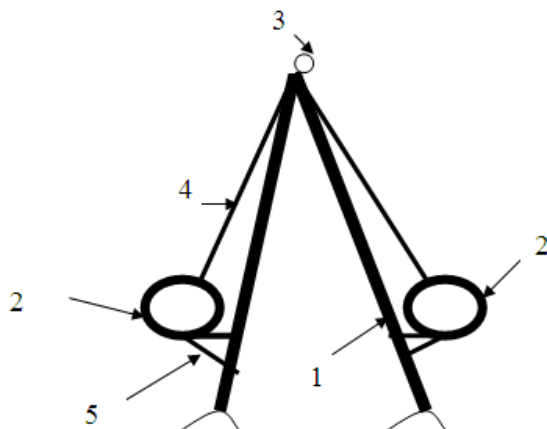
Поперечный разрез мостотоннеля в створе пилонов: 1 - стойки пилона; 2 – труба – балка жесткости; 3 – кабель; 4 – подвески; 5 - ригели пилонов.
